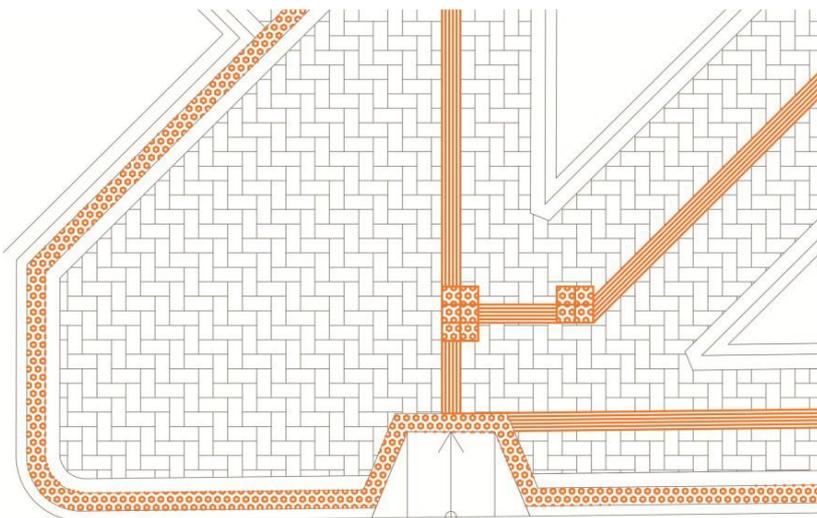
Sinalização tátil de alerta - Modulação do piso (Dimensões em milímetros)
